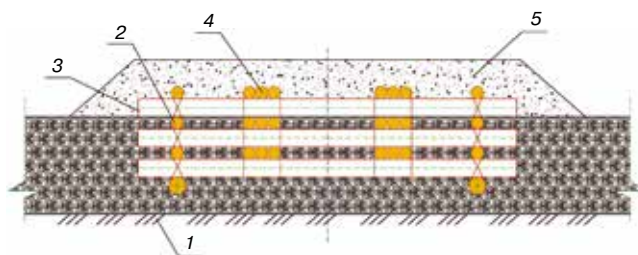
Лежневка для переувлажненных почв: 1 – плотный нижний слой грунта; 2 – слани продольные; 3 – поперечный баланс из шпал или бревен; 4 – продольный колесопровод из хлыстов; 5 – верхний грунтовый слой дорожной одежды
